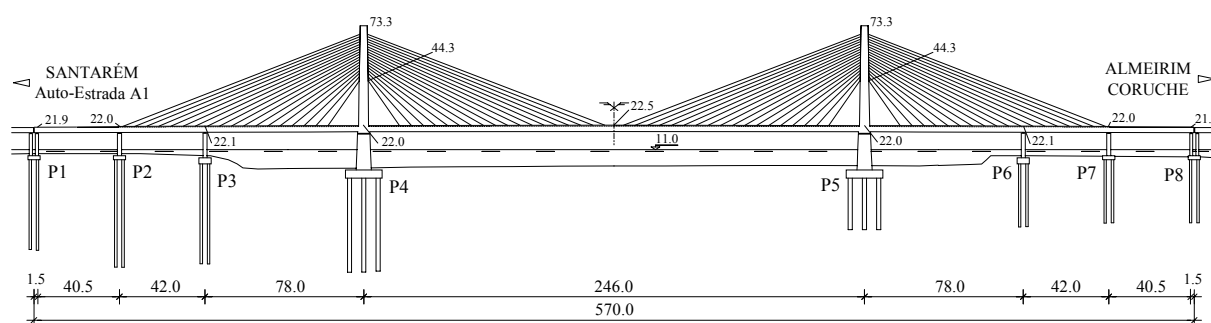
Corte longitudinal da ponte Salgueiro Maia.
